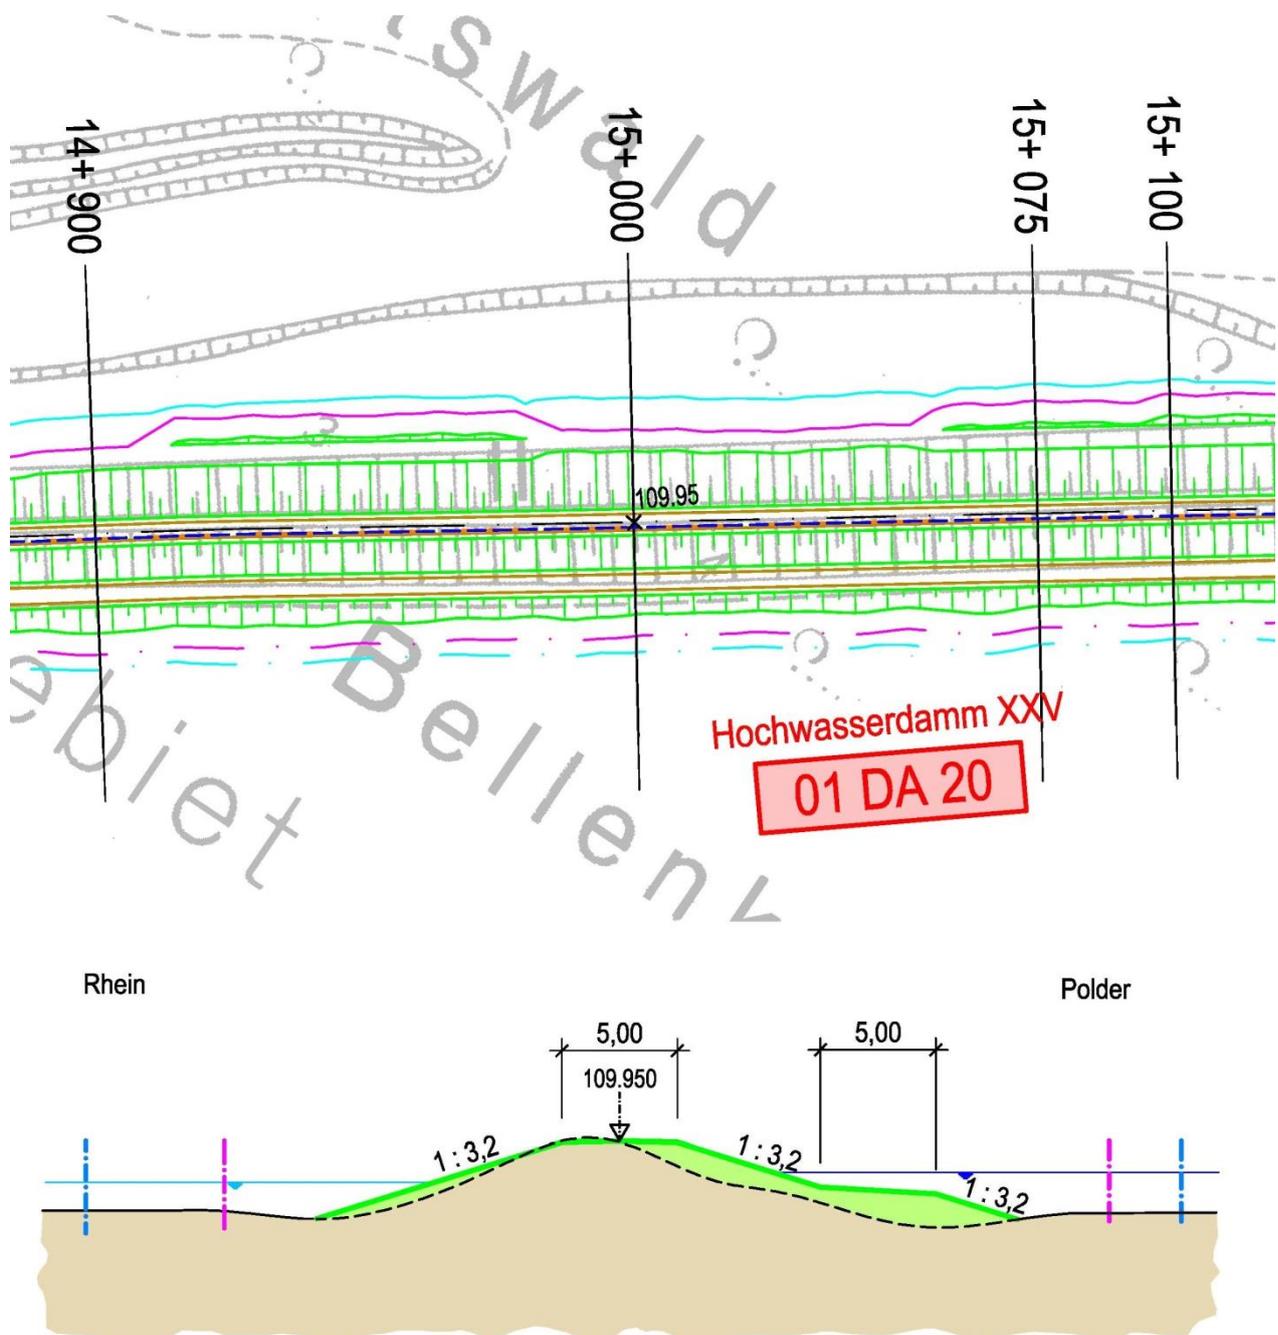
Lageplan und Querschnitt der Antragslösung
